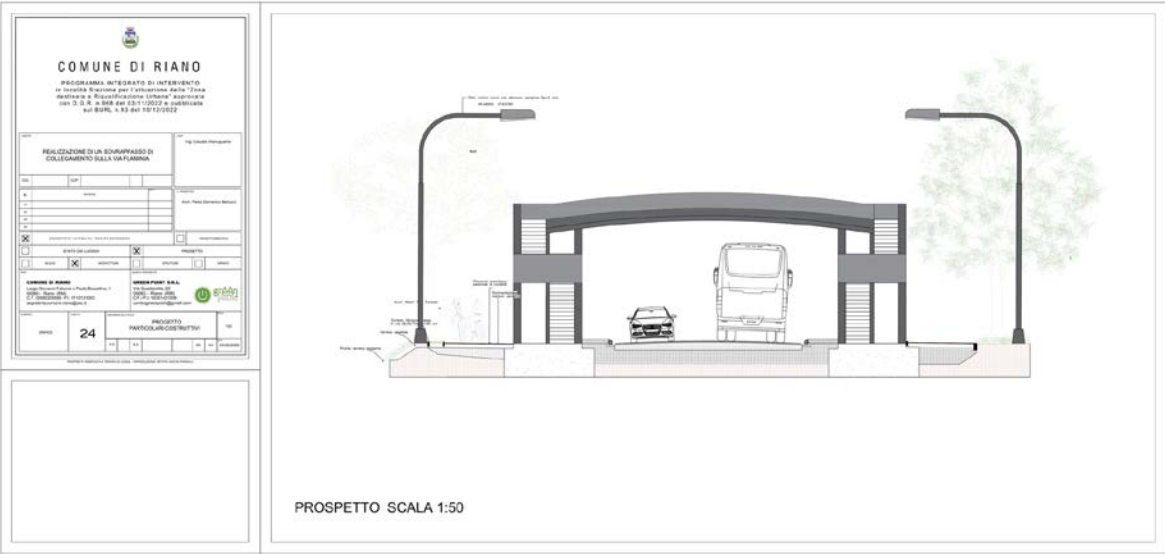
A24 Particolari costruttivi: prospetto e dettagli del sovrappasso
